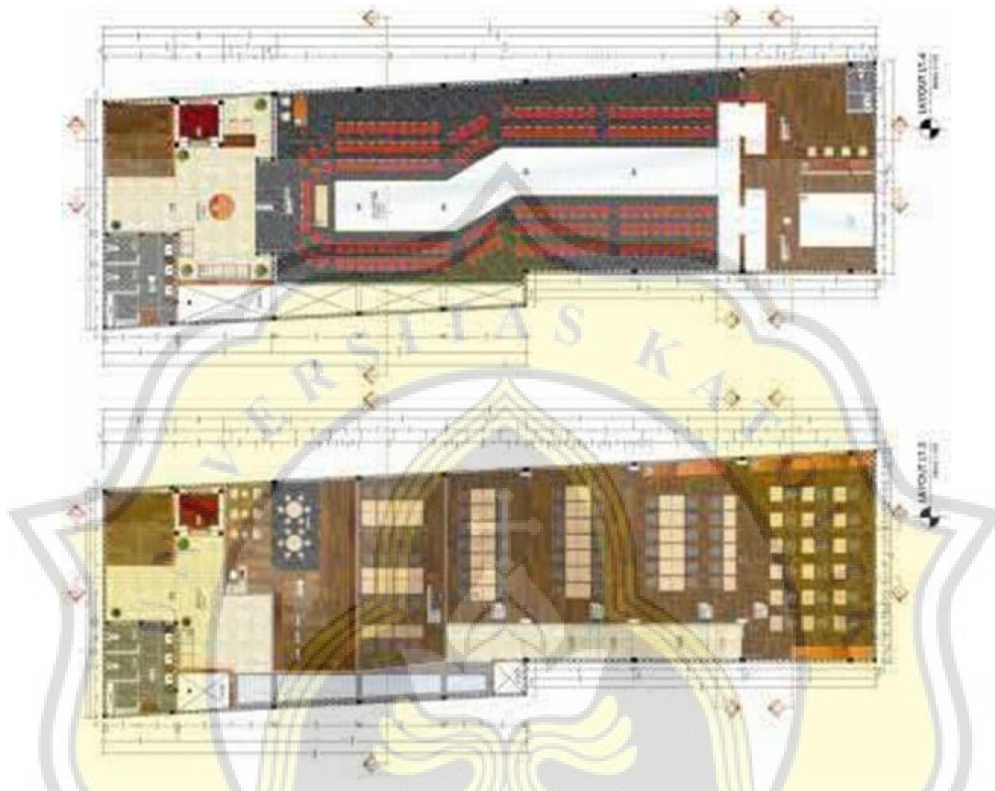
Denah Lantai 1 dan Lantai 2 Sekolah Fashion ARVA
